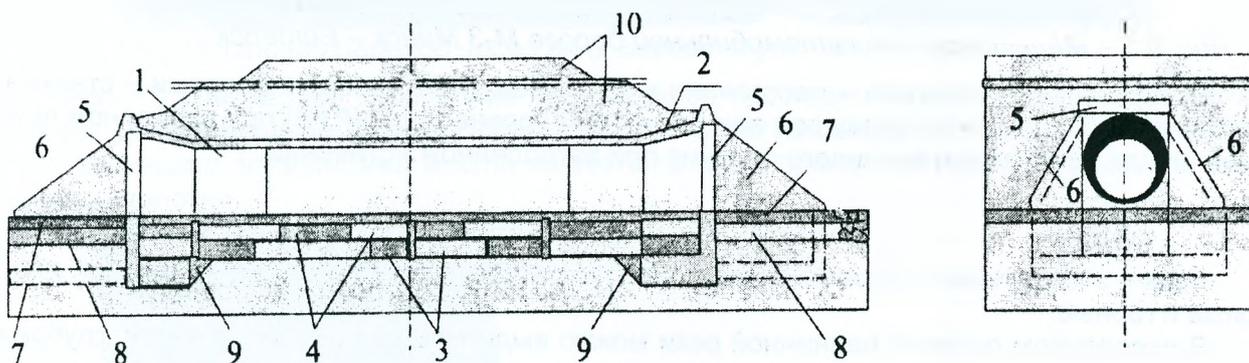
Элементы унифицированной водопропускной трубы: 1 – цилиндрические звенья; 2 – конические звенья; 3, 4 – фундаментные блоки; 5 – порталные стенки; 6 – откосные крылья; 7 – монолитный бетонный лоток; 8 – щебеночная подготовка; 9 – щебеночная подготовка; 10 – насыпь
